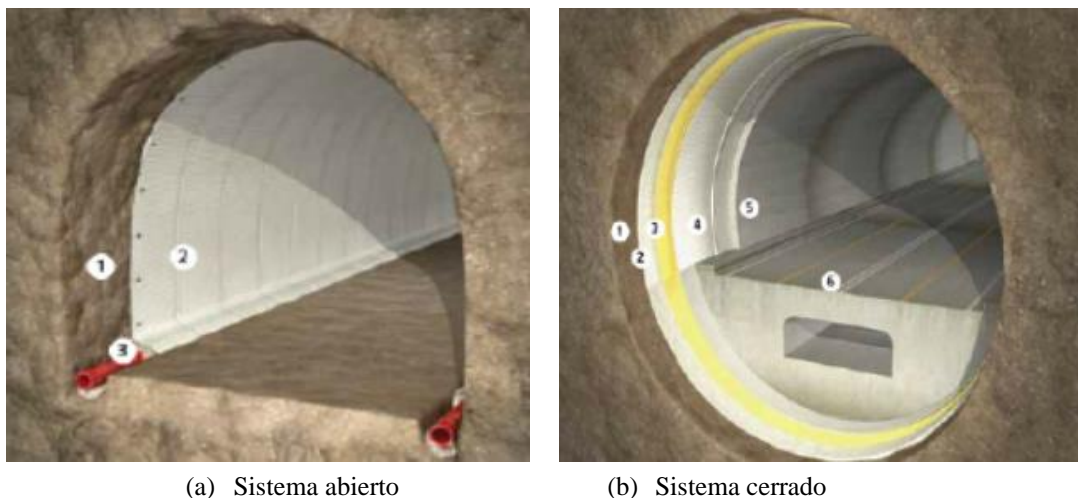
Sistemas de drenaje. (a) Tipo paraguas con protección perimetral, captación con tubos de drenaje laterales y/o centrales. (b) Con protección perimetral completa (túnel estanco), hormigón colado impermeable y/o sistema de membrana PVC.
